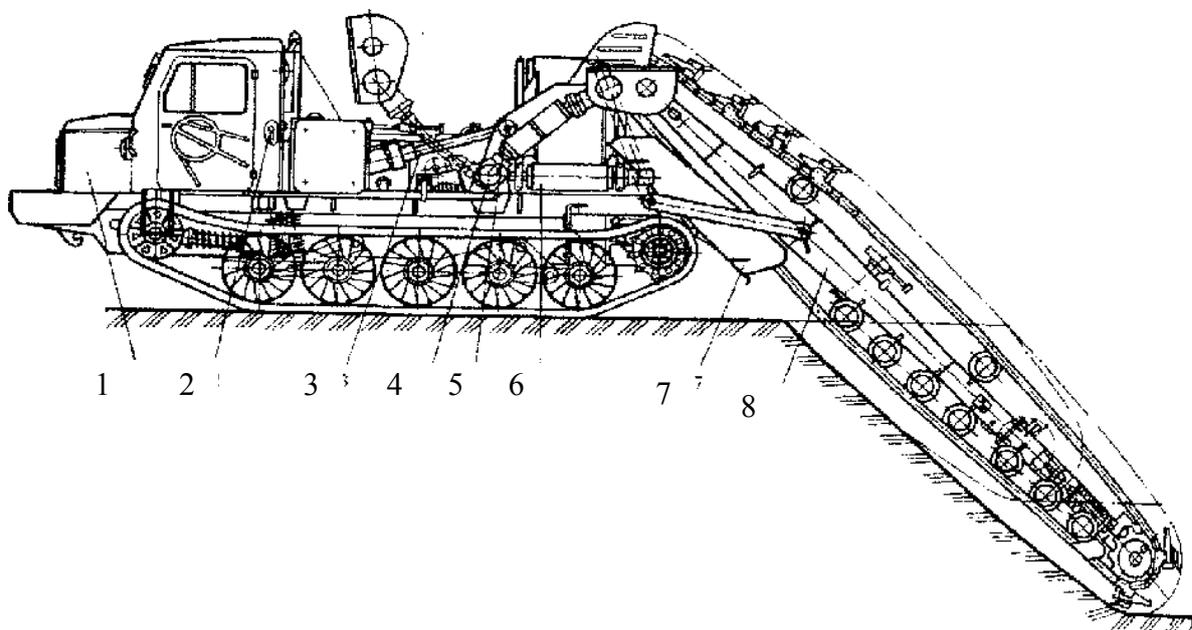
Многоковшовый цепной траншейный экскаватор: 1 – двигатель; 2 – базовая машина; 3 – гидроцилиндр; 4 – распределительная коробка; 5 – механизм подъема-опускания рабочего органа; 6 – конвейер; 7 – лоток; 8 – рабочий орган
